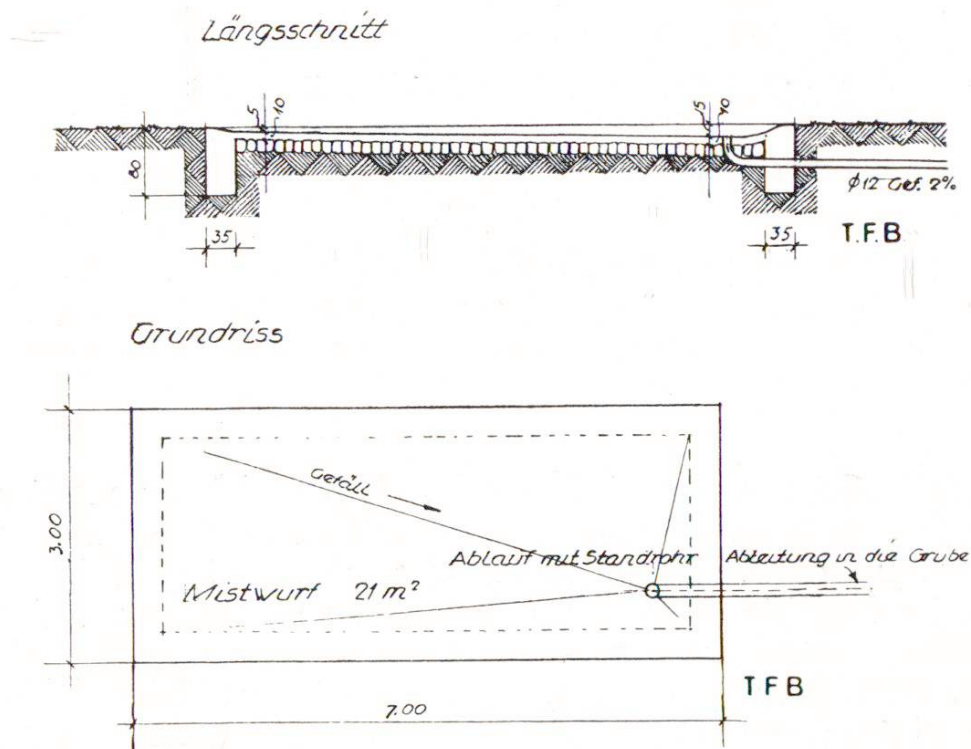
Aire à fumier de 21 m<sup>2</sup>. Coupe longitudinale et plan
